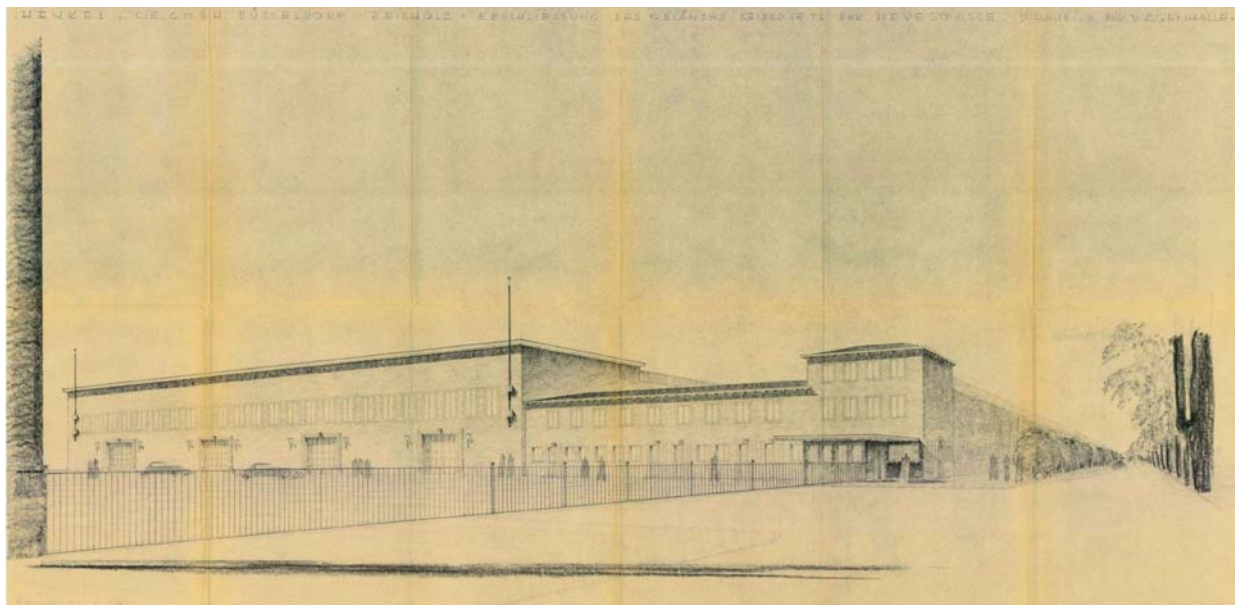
Schaubild der Wagen- und Gefolgschaftshalle mit Erschließung des Geländes zur Heyestraße (heutige Henkelstraße) mit Postamt und vom 22.05.1939 – Architekt: Walter Furthmann
